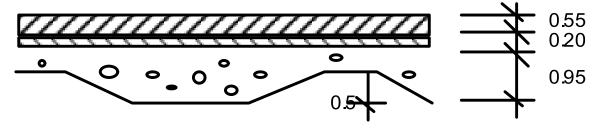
Coupe de la sous-couche SPORISOL au droit d'un plot
